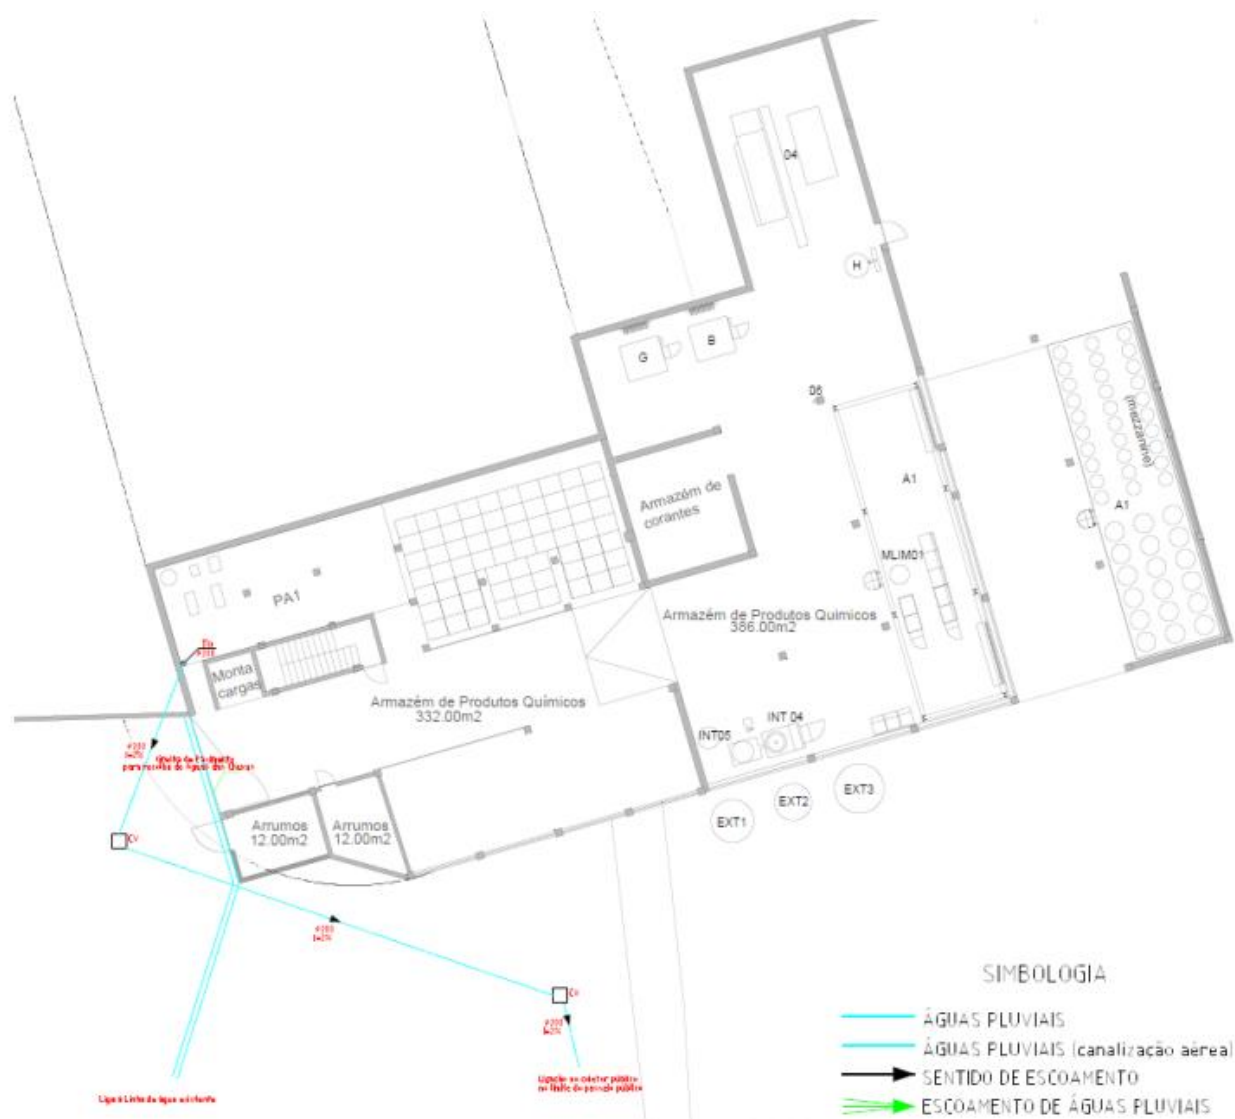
Planta de esquemática da rede de águas pluviais da cave do Projeto
